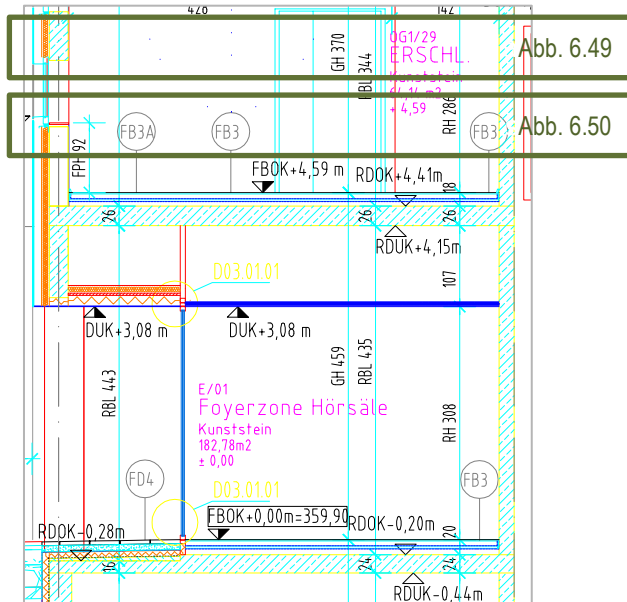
Ausschnitt aus Schnitt B-B, welcher den betrachteten Detailpunkt AWD02 darstellt [Quelle: Planunterlagen Arch. Zinterl]
